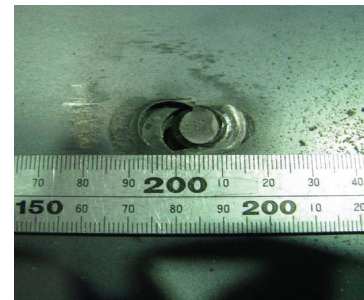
ボルトおよび鋼板損傷状況 (U0-R8)
